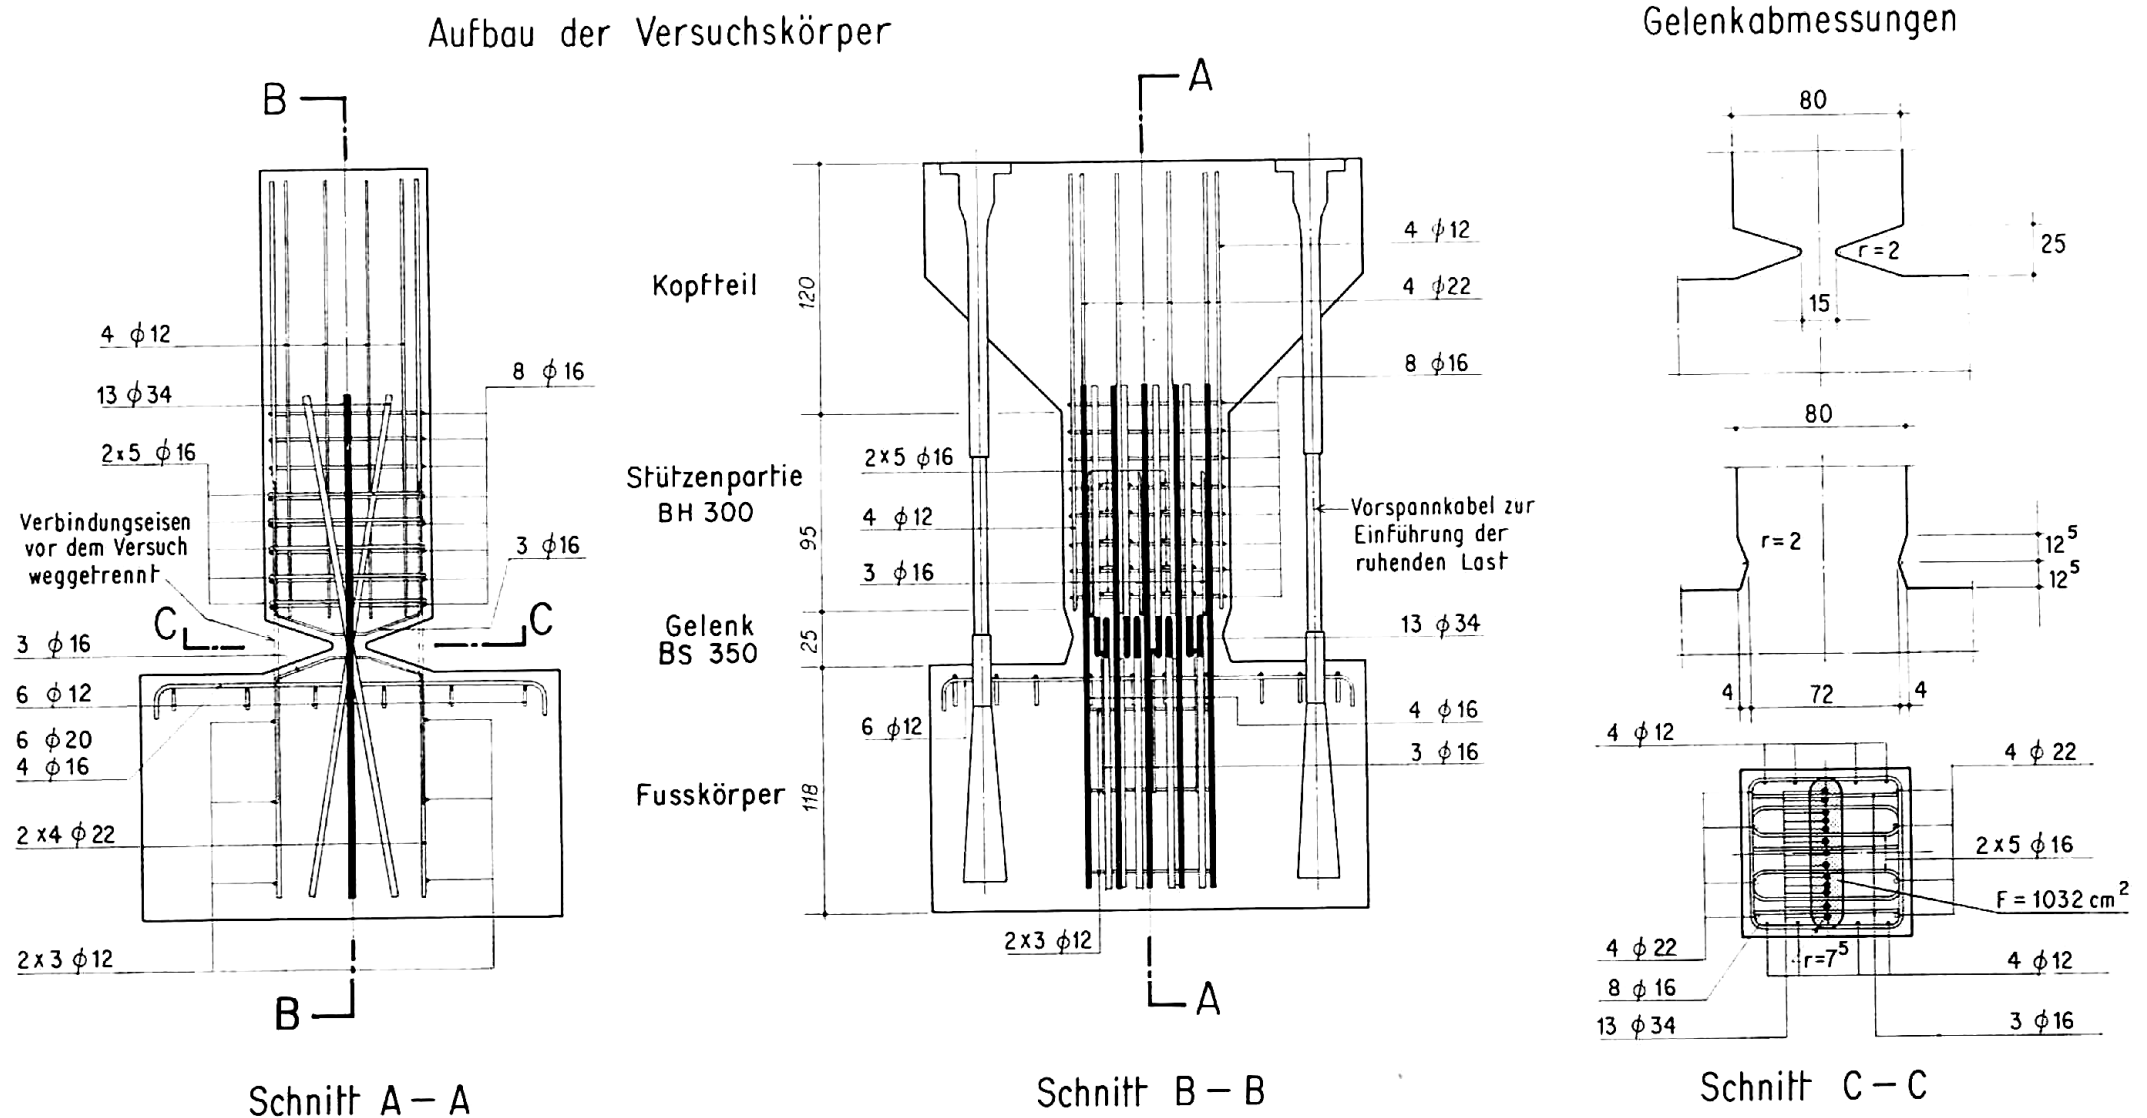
Aufbau, Armierung und Abmessungen der Betongelenk-Versuchskörper
